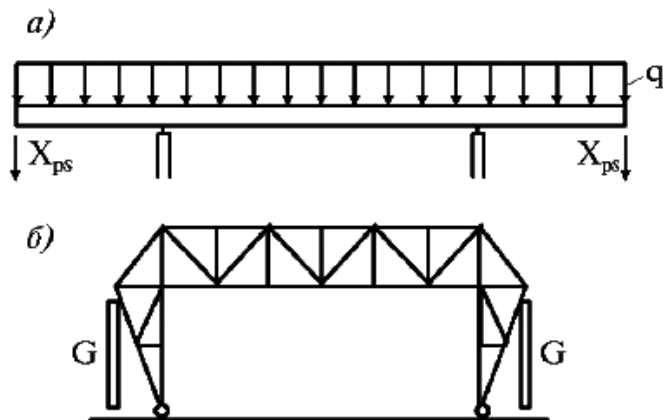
Пригруз (X_{ps}) на консолях и подвеска стен к раме
